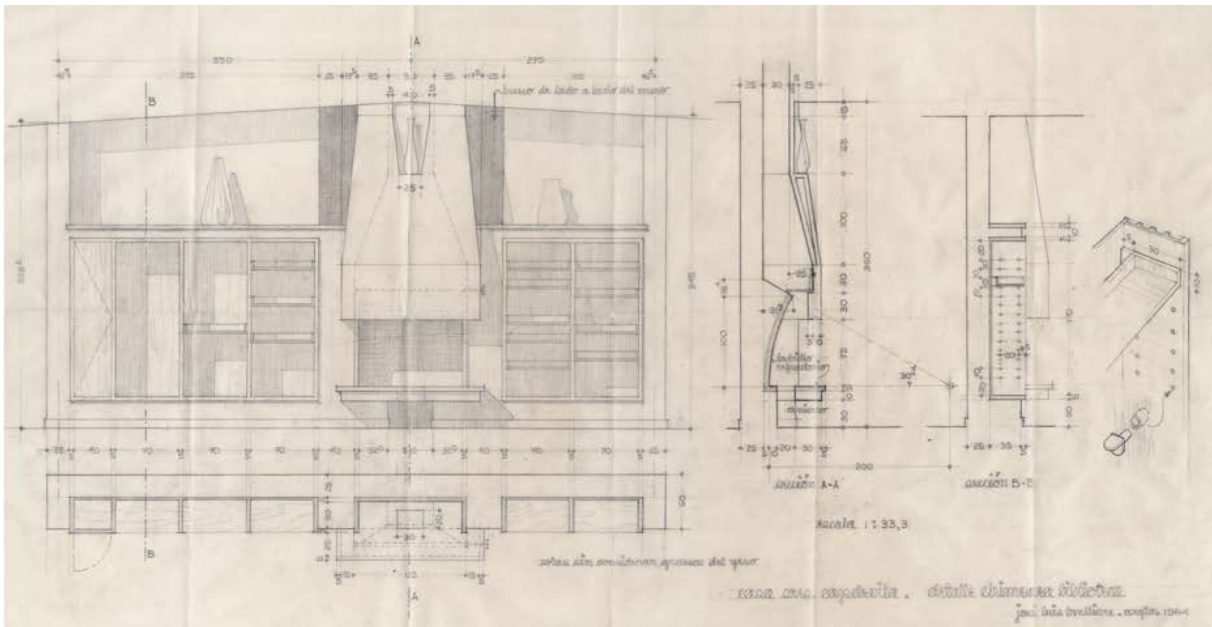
Detalle de la chimenea de la biblioteca. 1964. Archivo Fundación Mariano Benlliure. Madrid
